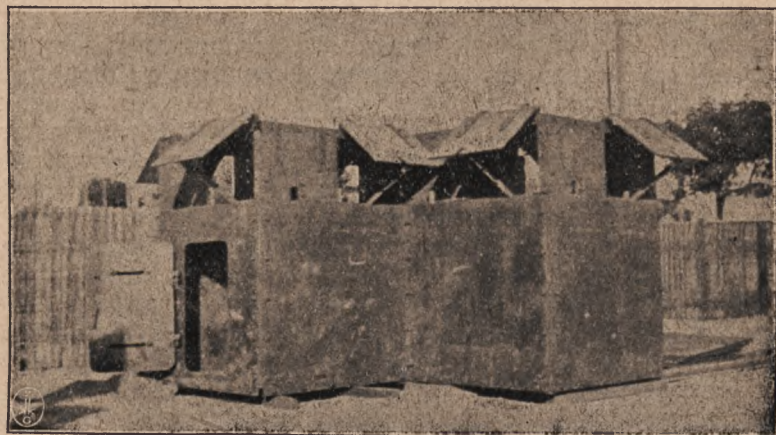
Typowy przykład obrony ulicy. Na przednim planie brama na kółkach, w głębi, na rogu ulicy — betonowy blokhauz.
